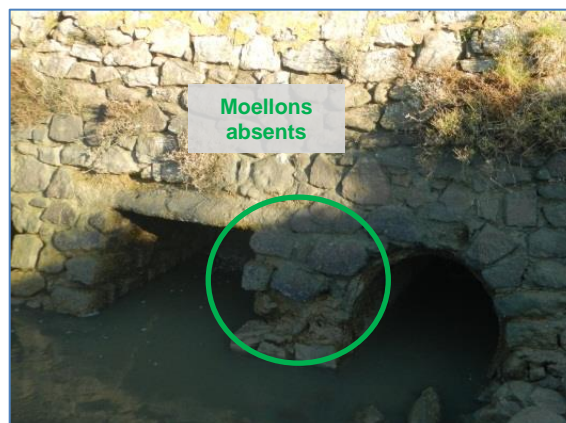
Pile dégradée sur le parement amont de l'ouvrage de Bérigo (ARTELIA - 2016)
